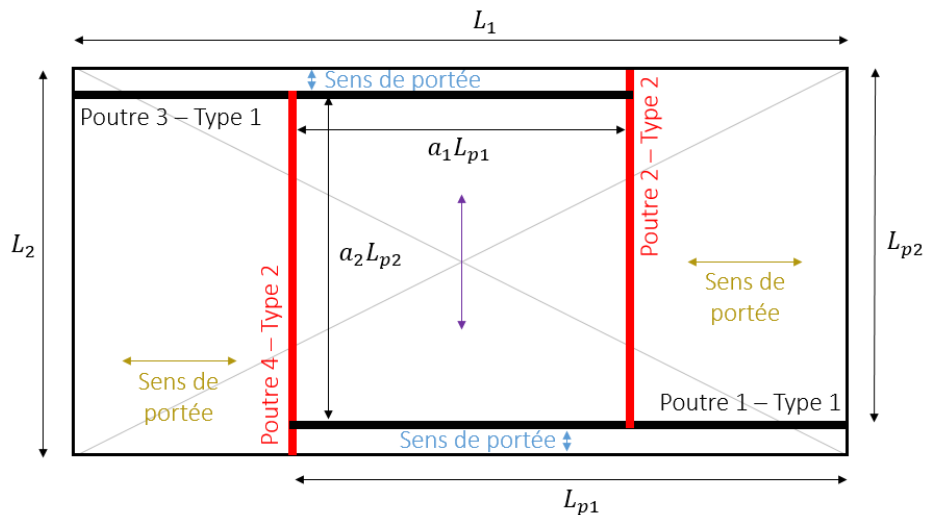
Plancher rectangulaire avec zone centrale carrée et 2 sens de portée
